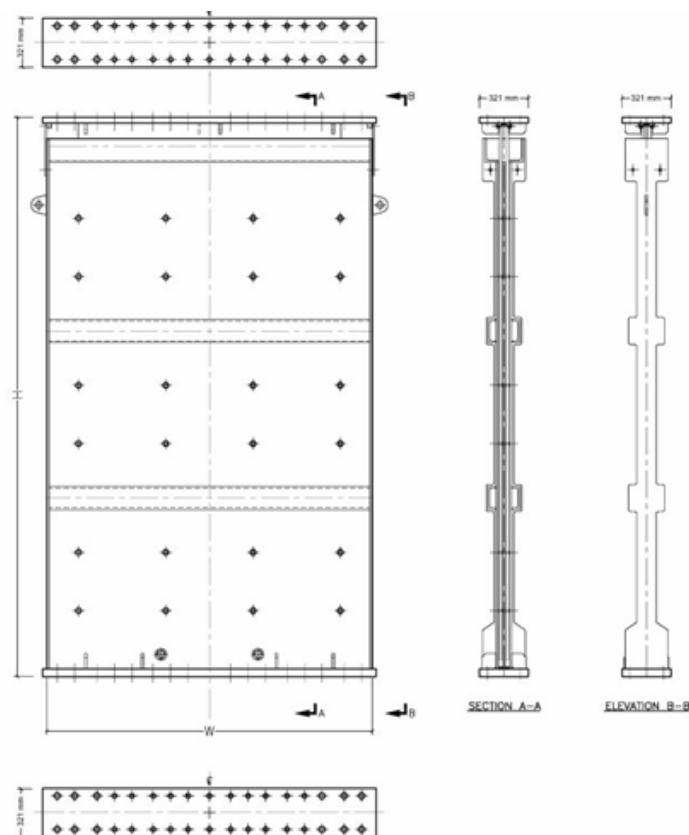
Viscous Wall Dampers (VMDs) (a)
